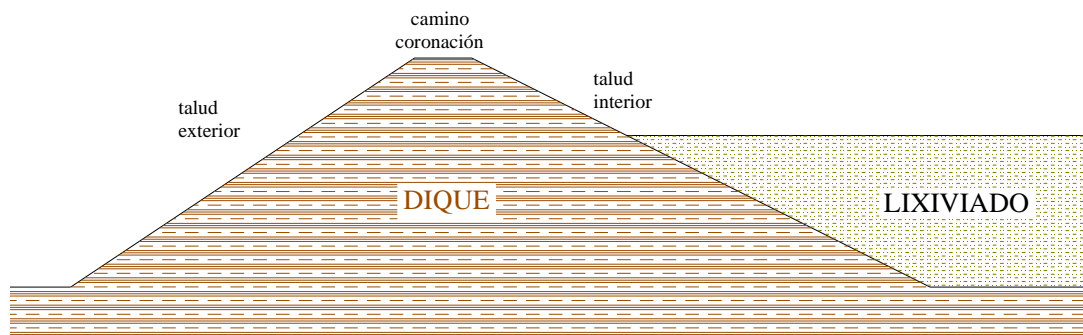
balsas de lixiviados con talud interior, talud exterior, impermeabilización y obras complementarias (tubería de entrada de HPDE, escalera de salvamento, vallado perimetral y anclaje de la tubería).
